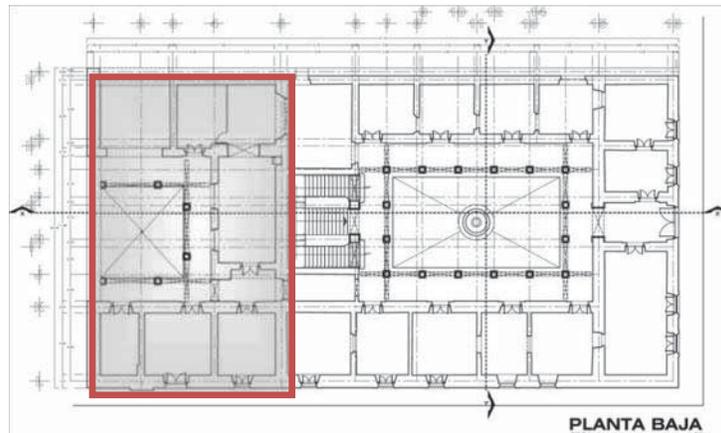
Áreas relacionadas con los Servicios en Planta Baja
